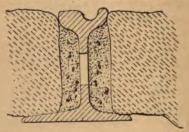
Voie Gowan, Échelle :  $\frac{1}{6}$
